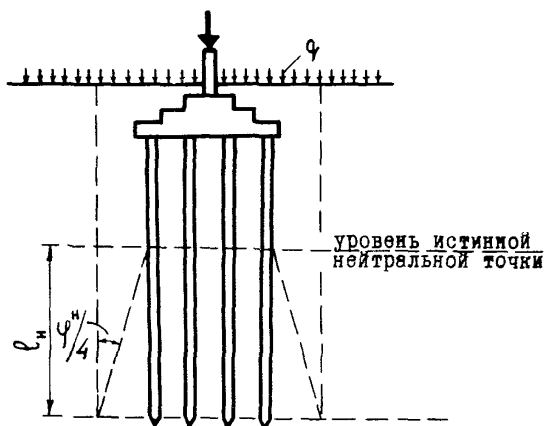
Схема определения границ условного фундамента при расчете осадок свайных фундаментов.
